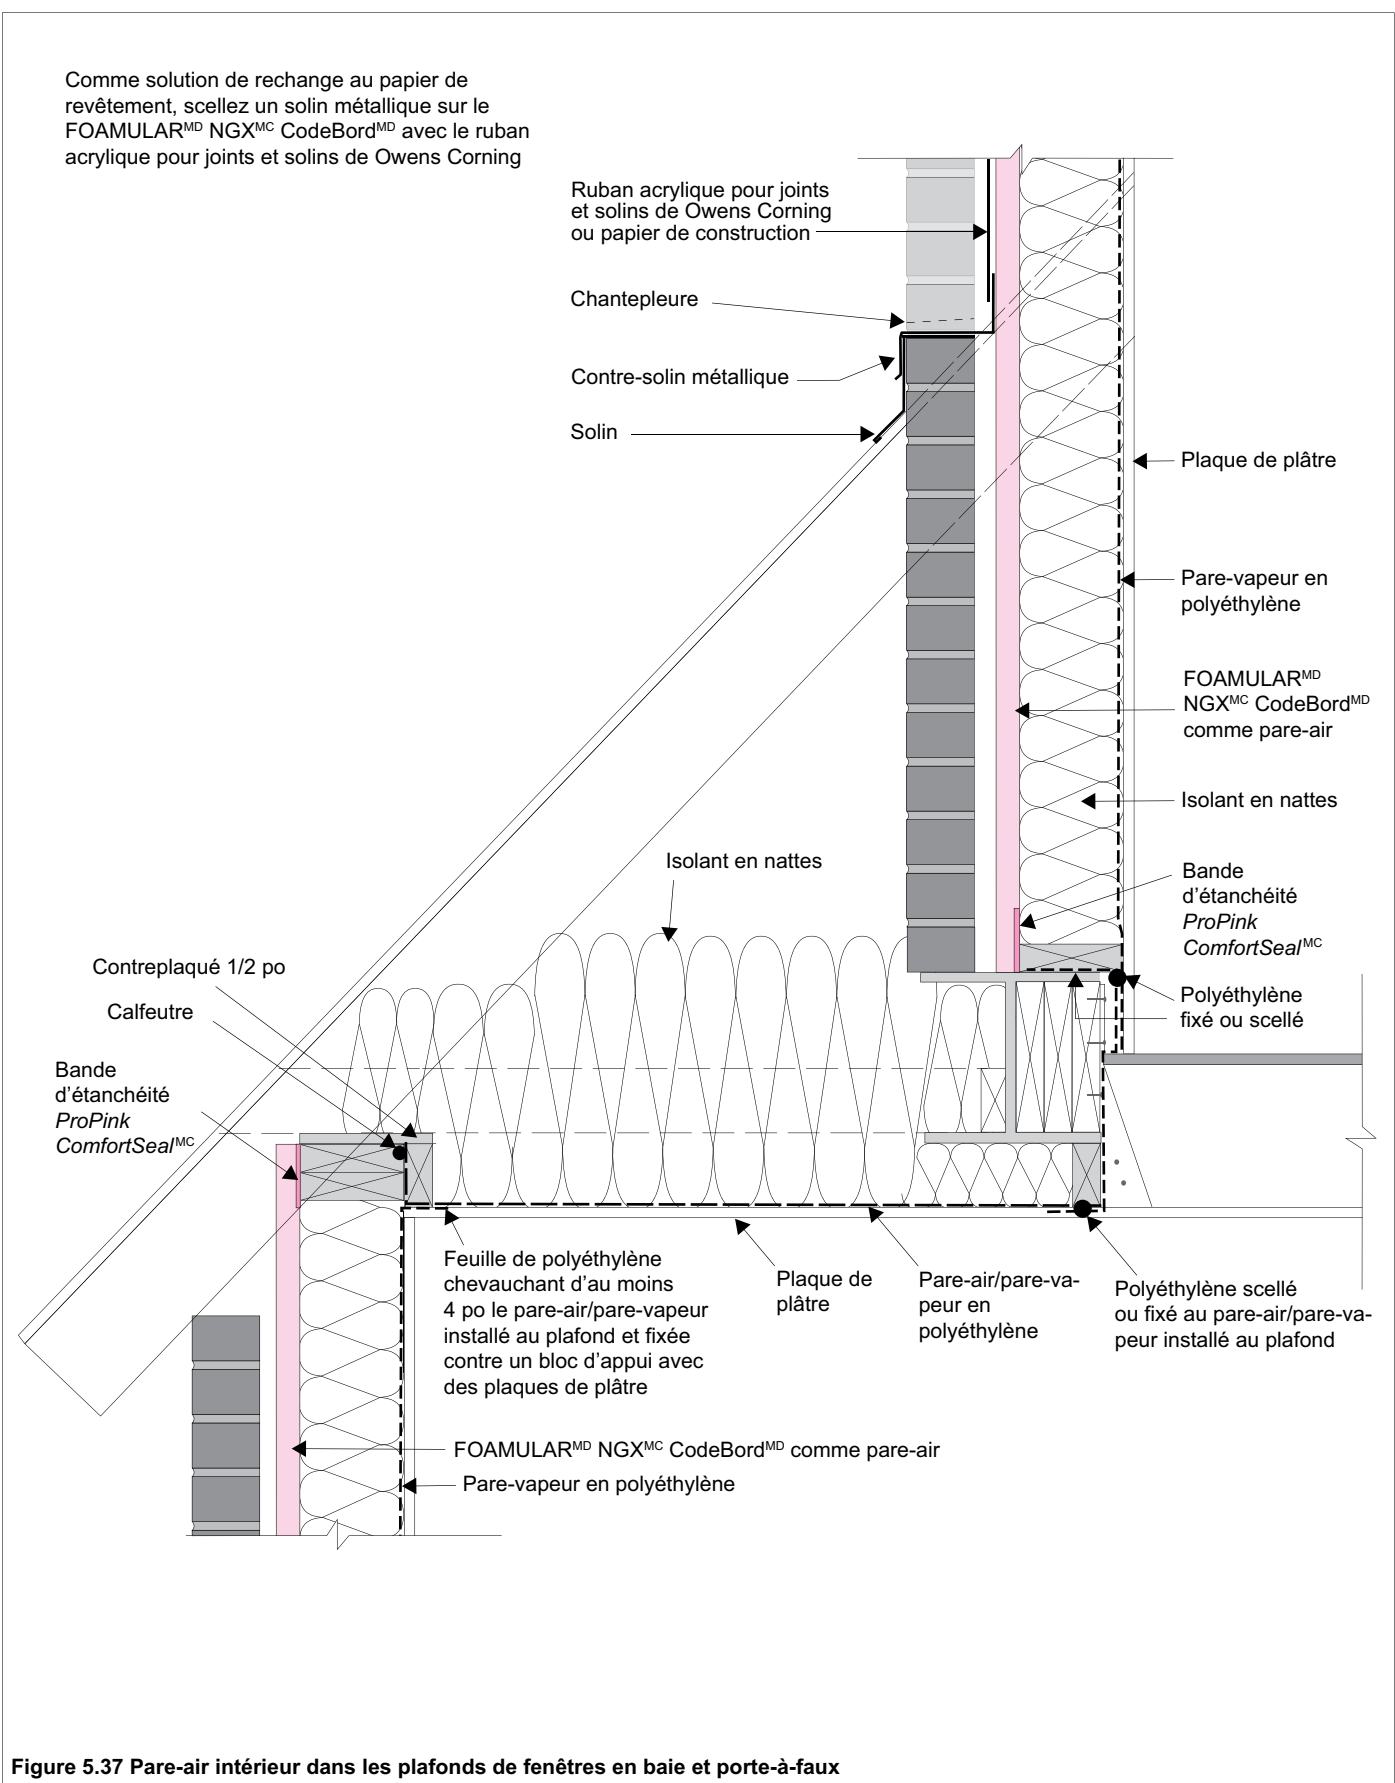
Pare-air intérieur dans les plafonds de fenêtres en baie et porte-à-faux
